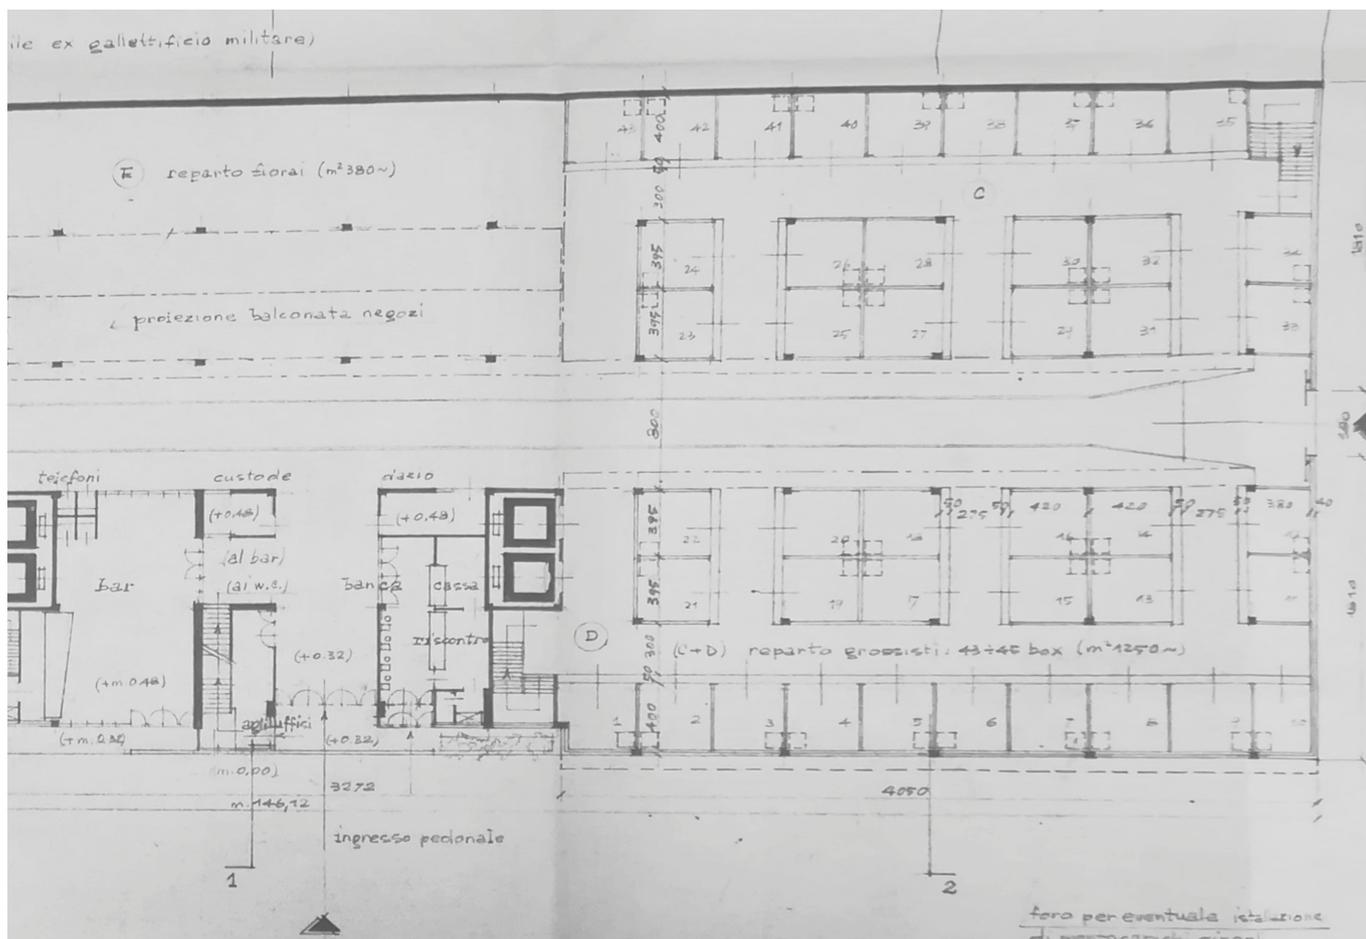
Progetto preliminare per il Mercato dei Fiori, pianta piano terra, arch. Cesare Bersia, Archivio storico di Torino
